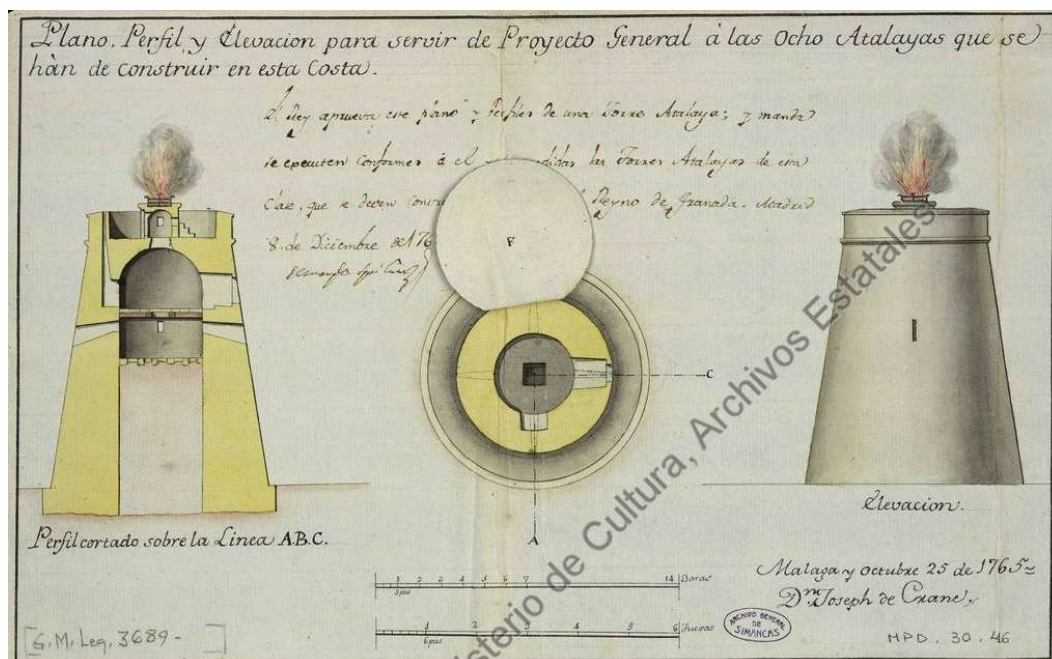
Plano, perfil y elevación del proyecto general para las ocho atalayas que han de construir en esta costa. (Planta superior). José de Crame, 1765. Archivo General de Simancas M.P.D. 30. 46.
